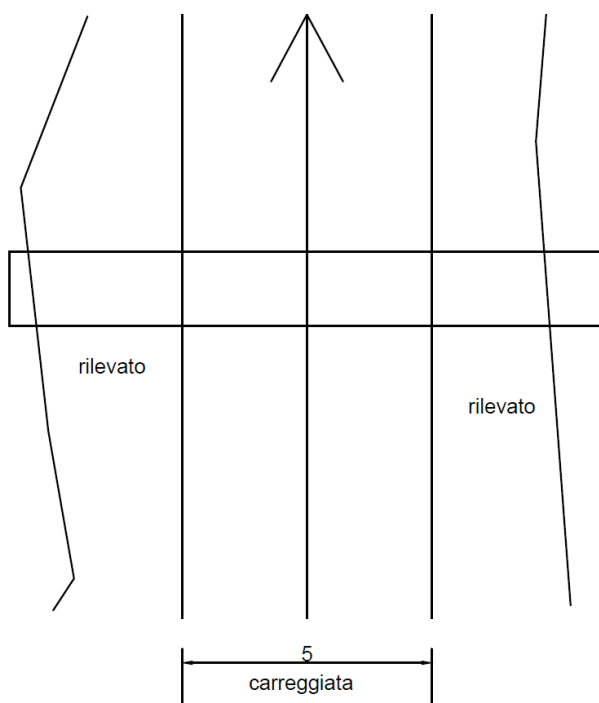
Indicazione della posizione dello scatolare rispetto alla strada in progetto - pianta
